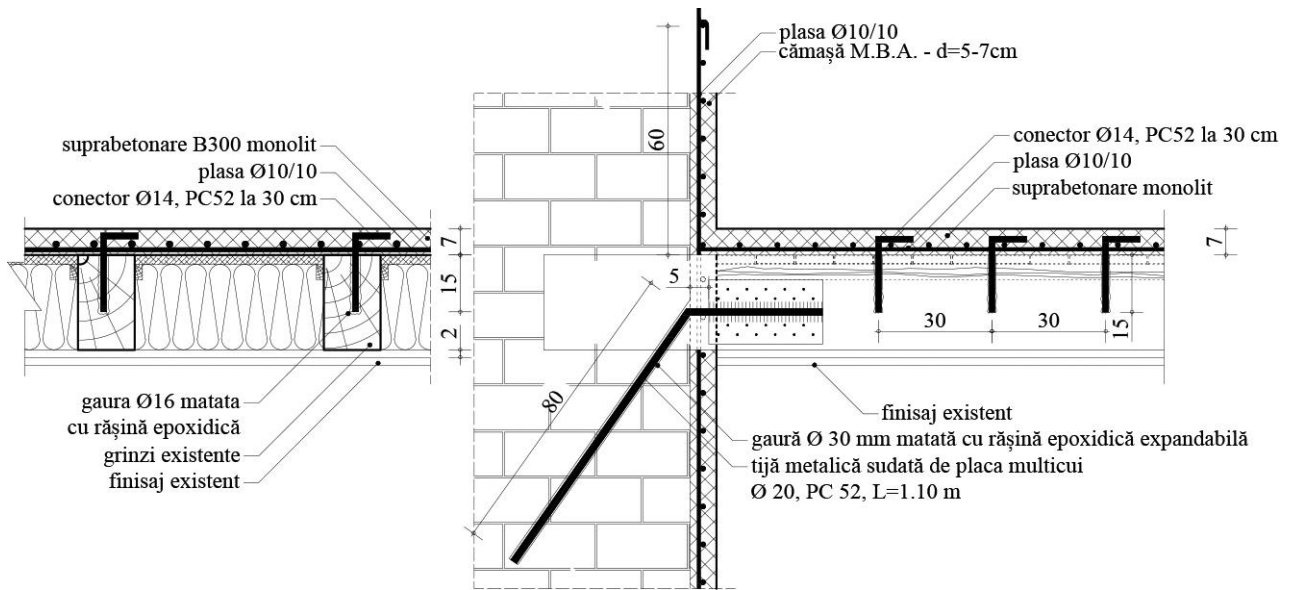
Variantă de consolidare a planșelor din lemn prin suprabetonare și conectori.
